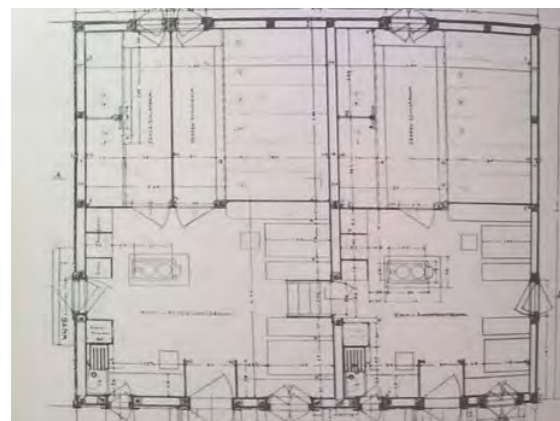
Pianta struttura prefabbricata della Modelserhütte.
